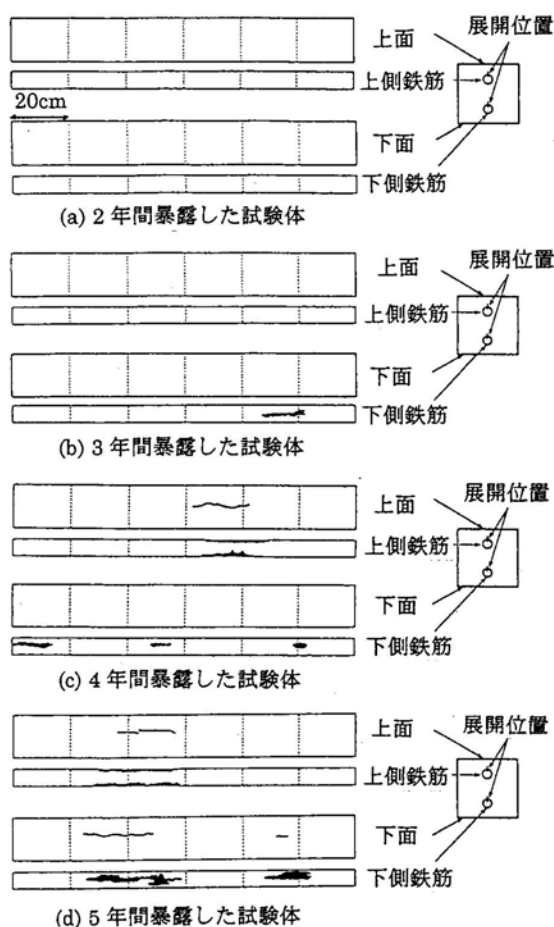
暴露試験体のひび割れおよび腐食状況
